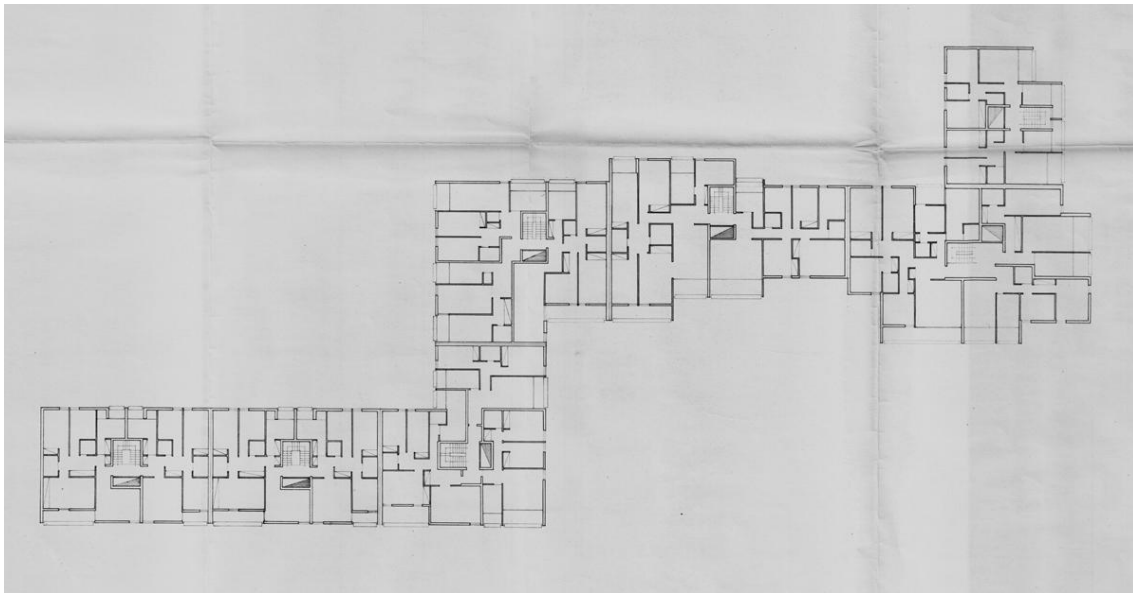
Plantas tipo, Luiz Carlos Silva Monteiro Cabral, s.d.⁸⁵⁹
